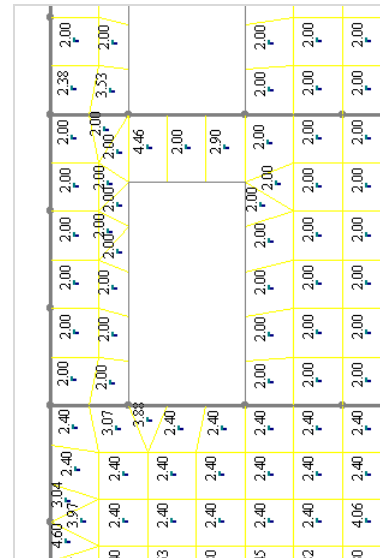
Расчетное армирование стены в графическом и цифровом виде (фрагмент)
